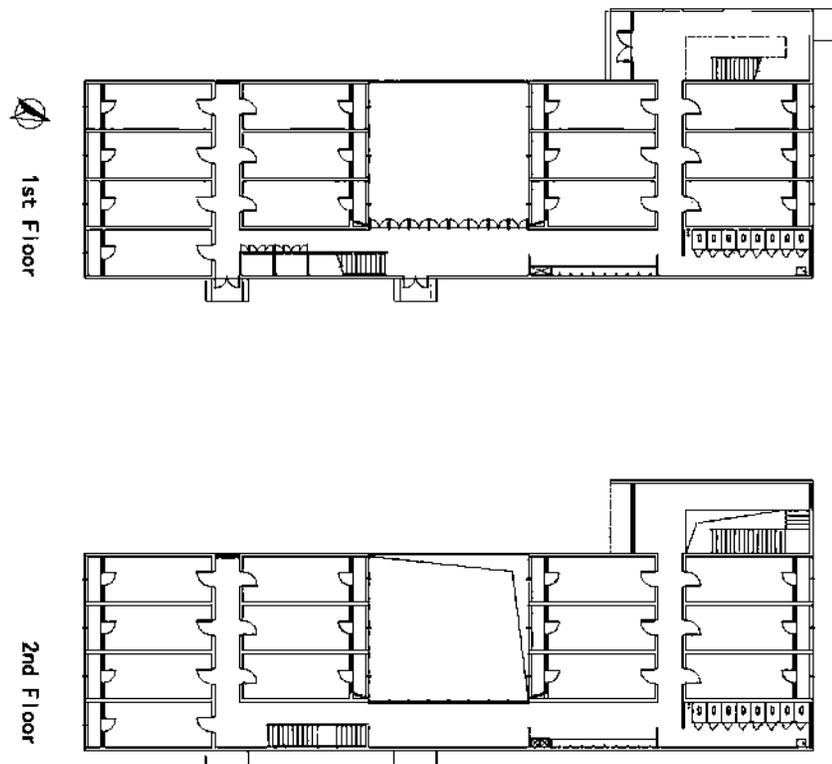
Plantas arquitectónicas del Albergue para estudiantes /Wuyang Architecture Fuente: ArchDaily
